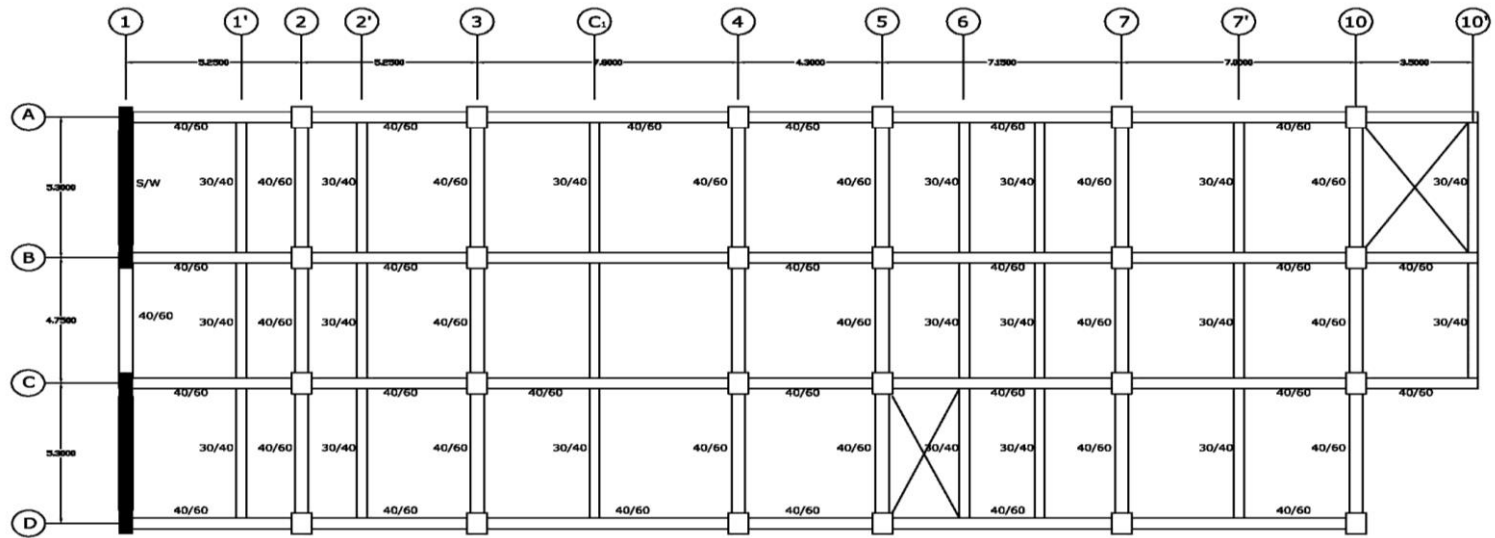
Denah Pembalokan Lantai 9 - 12
